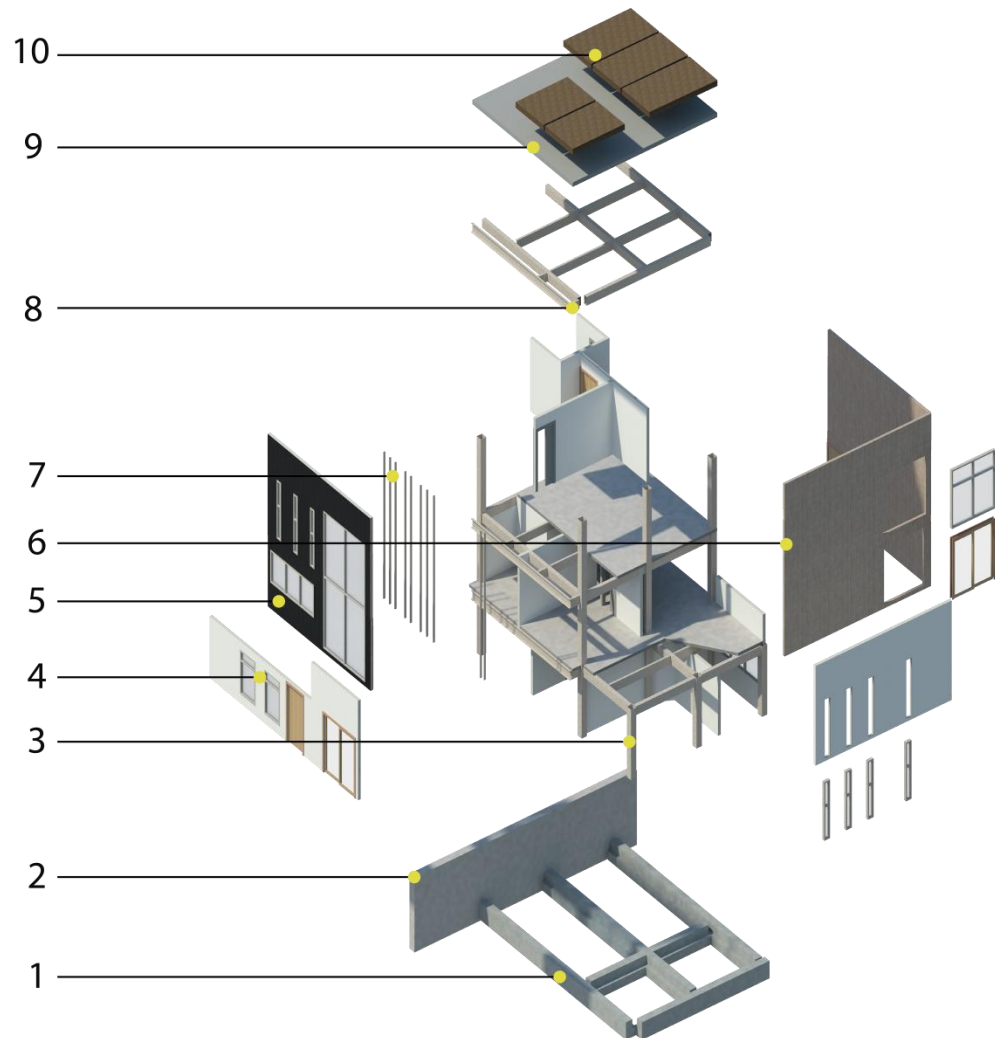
Axonometría explotada sistema constructivo. Fuente: Propia
